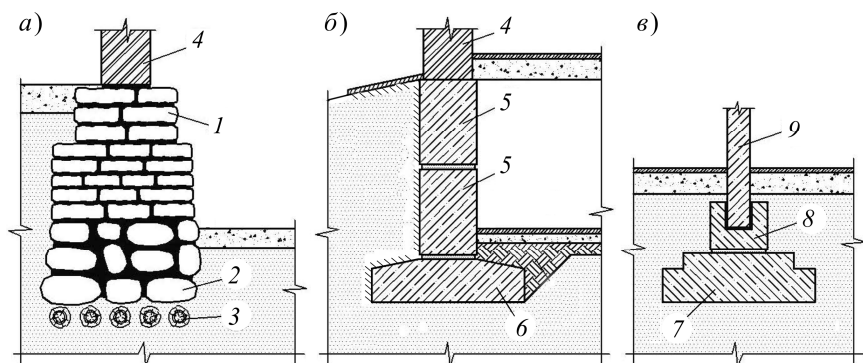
Поперечные разрезы типичных фундаментов мелко заложения:
